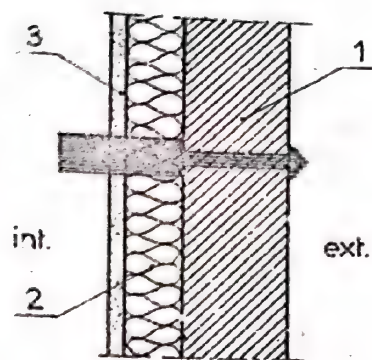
Perete de beton cu termoizolație la interior. 1-Beton; 2-Izolație termică; 3-Tencuială interioară.
